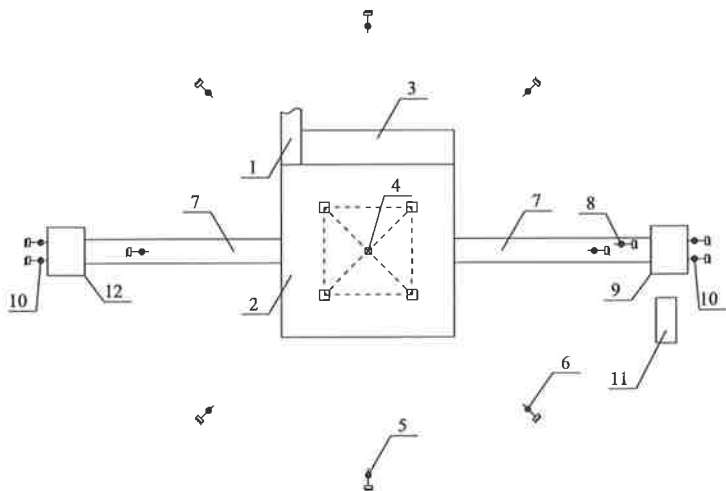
座地四摇臂抱杆分解组塔现场平面布置示意图
